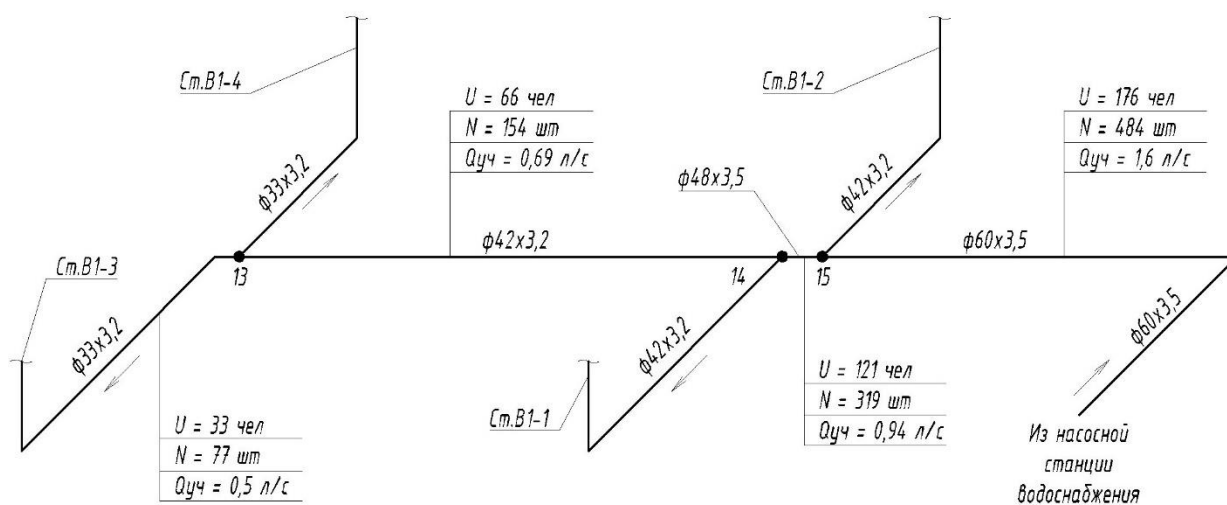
Расчетная схема расходов воды на участке сети водоснабжения от стояка Ст.В1-3 до помещения насосной.
